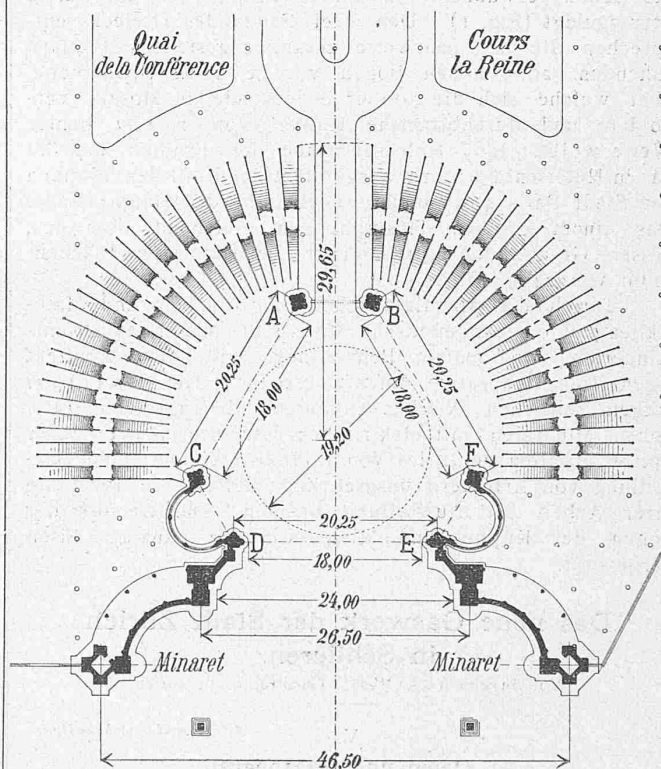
Grundriss der Haupteingangs-Halle. 1:720.
